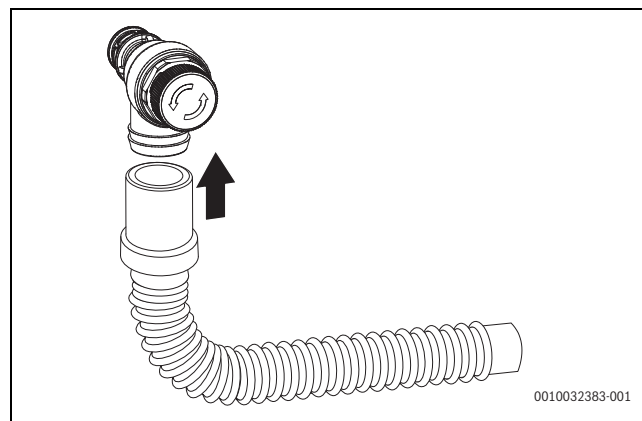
Montage du tube sur la soupape de sécurité (chauffage)
